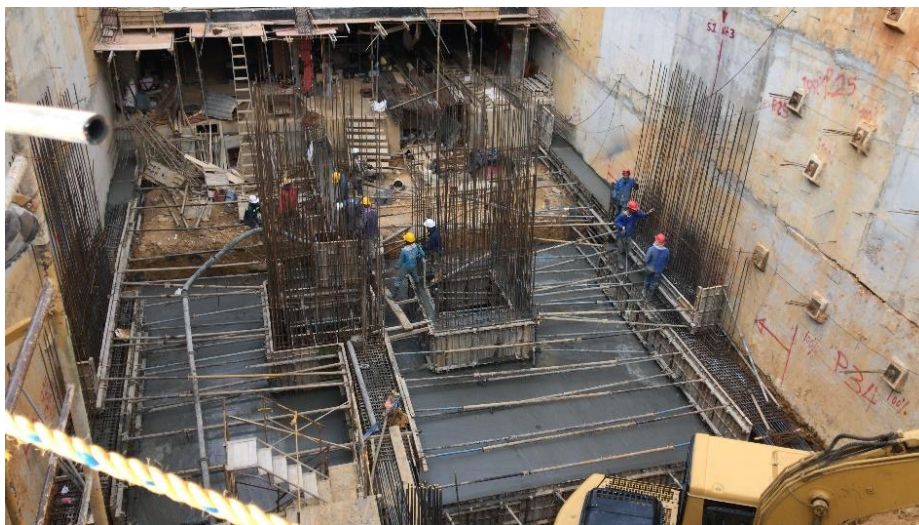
FUNDIDA DE ZAPATA Y VIGAS DE CIMENTACION.
